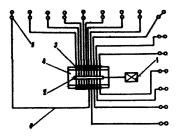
Схема параллельного присвединения домкратов к насосной станции:
